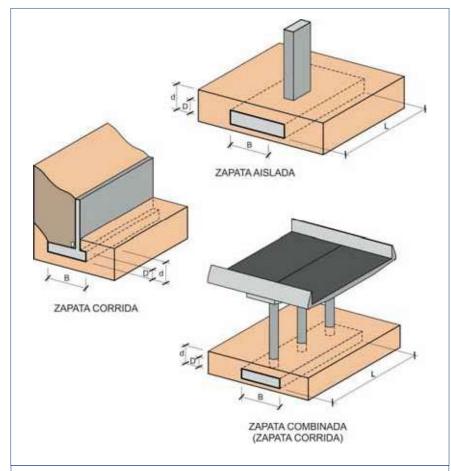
Tipos de cimentación superficial contemplados en la Guía
